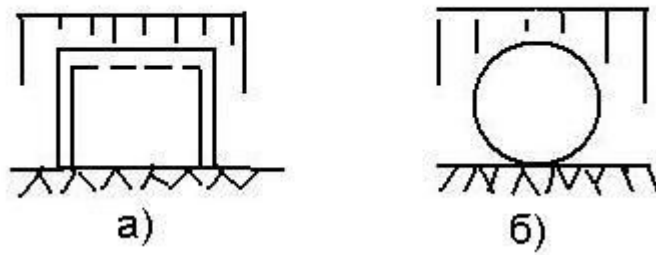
Трубы в насыпи прямоугольного очертания больше деформируются, чем круглые.
